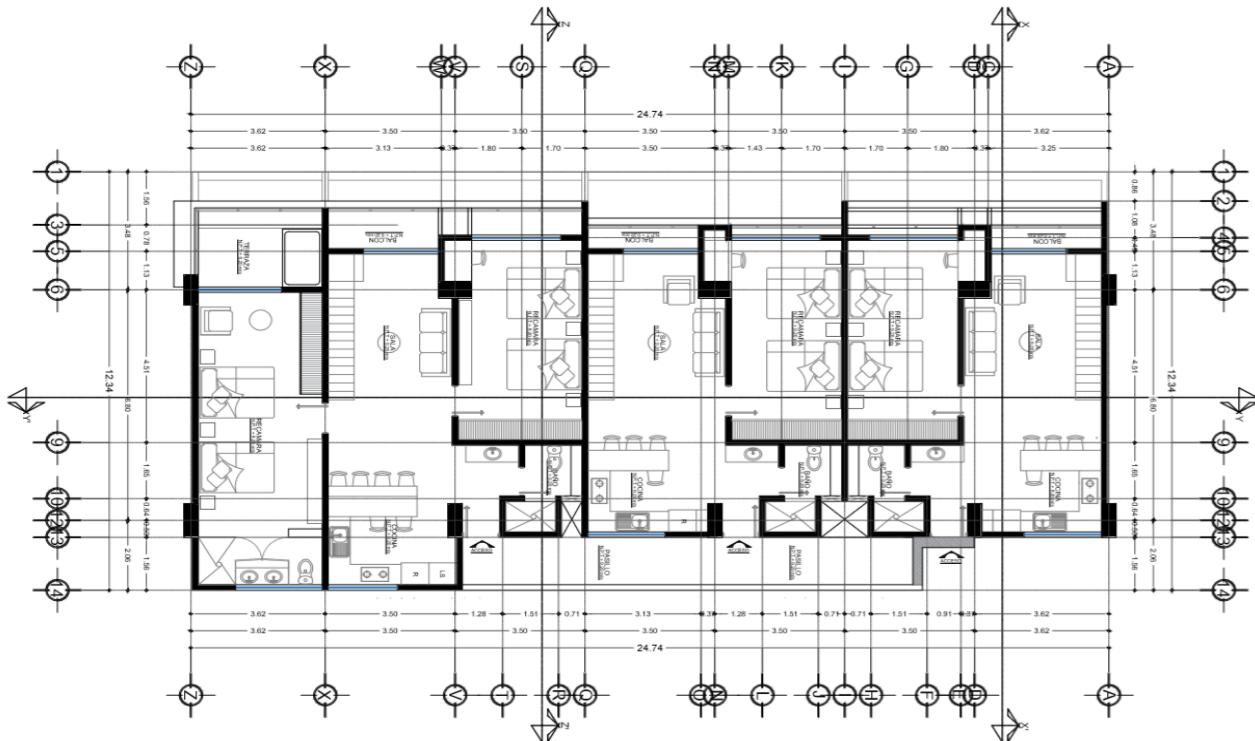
Planta arquitectónica del tercer nivel del Edificio A.
